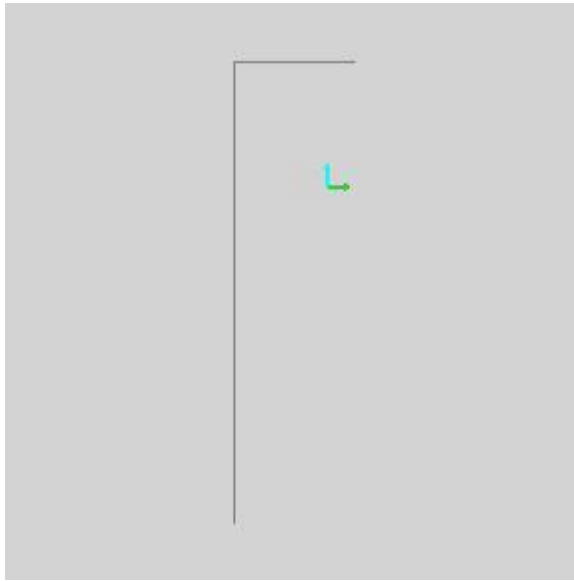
Perímetro de punzonado de columna C2 del bloque 1.
